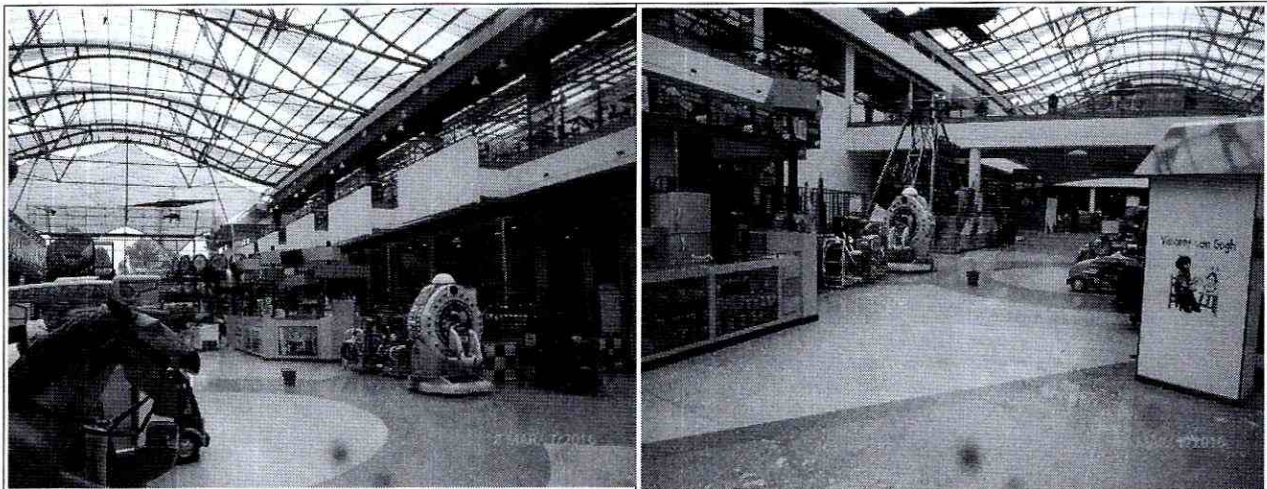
Y 6. Zona de Juegos infantiles no se evidencian afectaciones en elementos estructurales.
